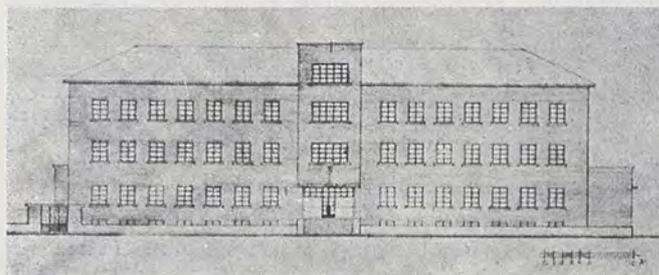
a - Convitto Biellese - I progetto: prospetto sulla via Tripoli.
